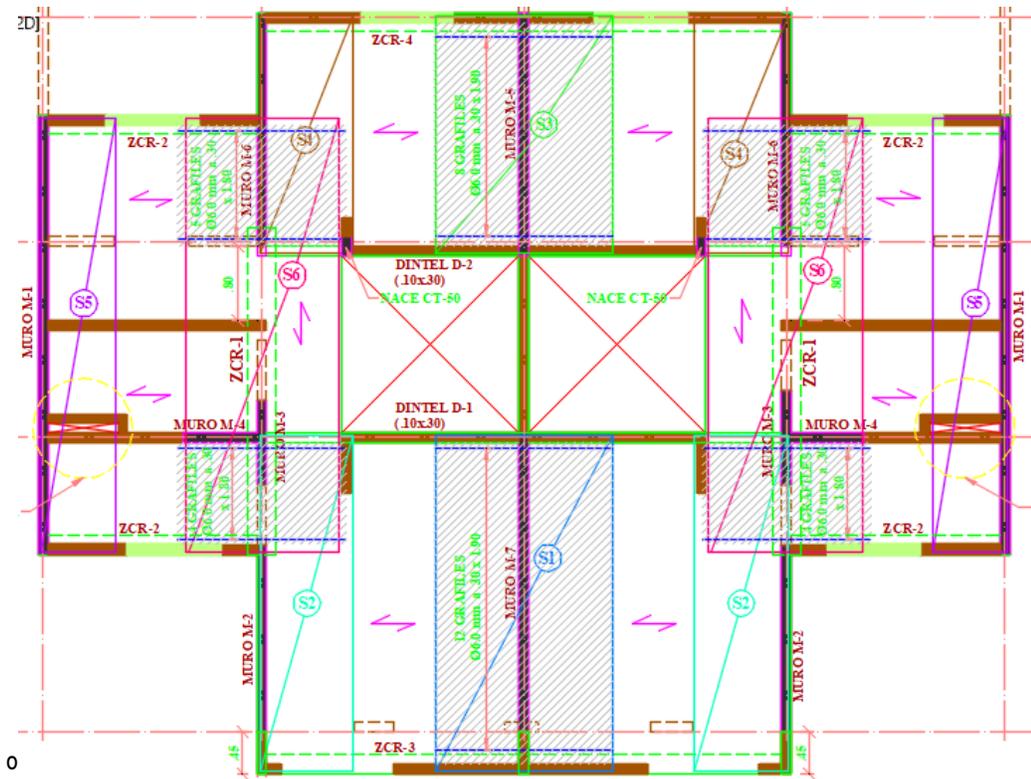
Refuerzo Superior Placa de Entrepiso para Pocha del proyecto Villas del Duruelo.
